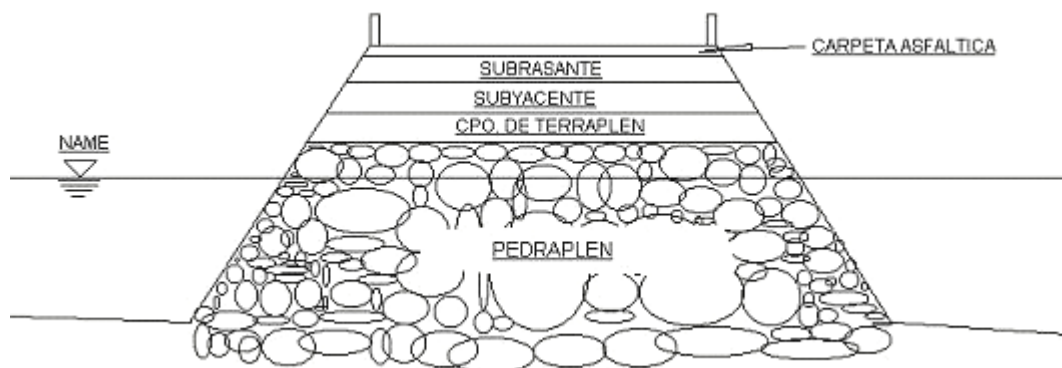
SECCIÓN TIPO PEDRAPLÉN.
